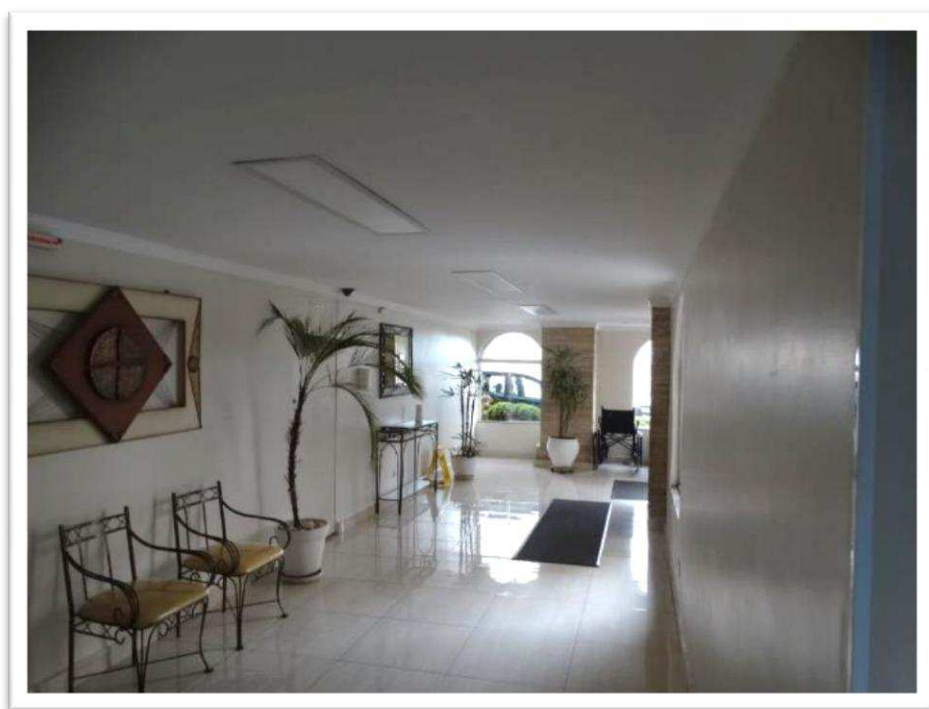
Vista do hall social, no pavimento térreo do bloco 17.
